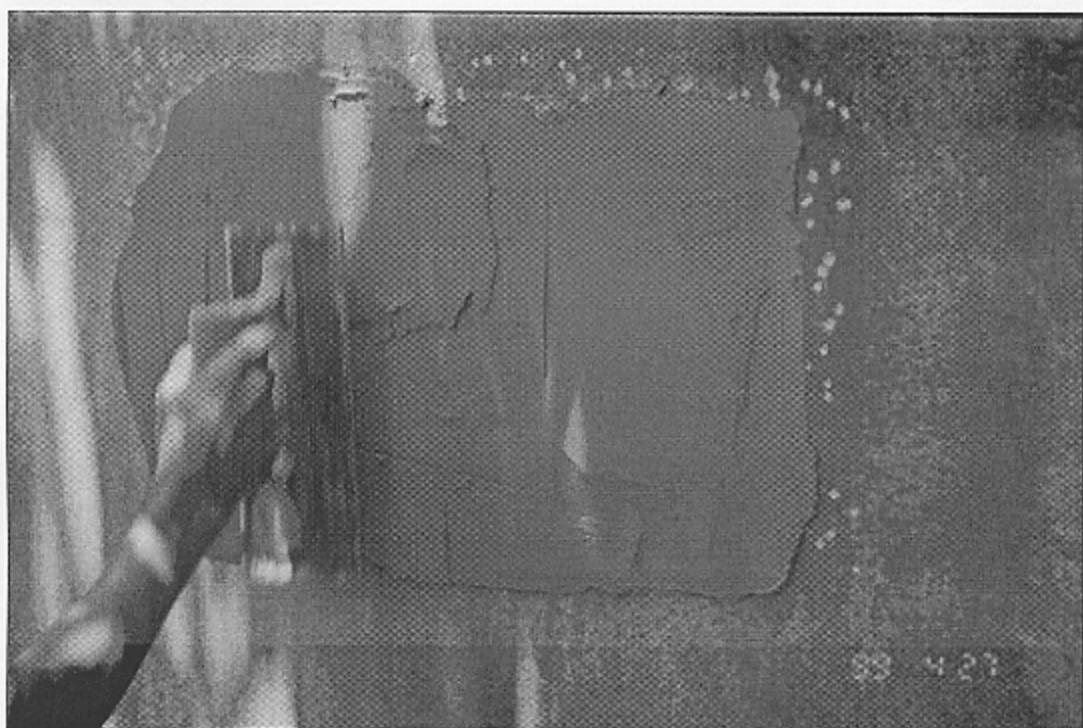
Muestra de enlucido de un Mortero con pigmento.
